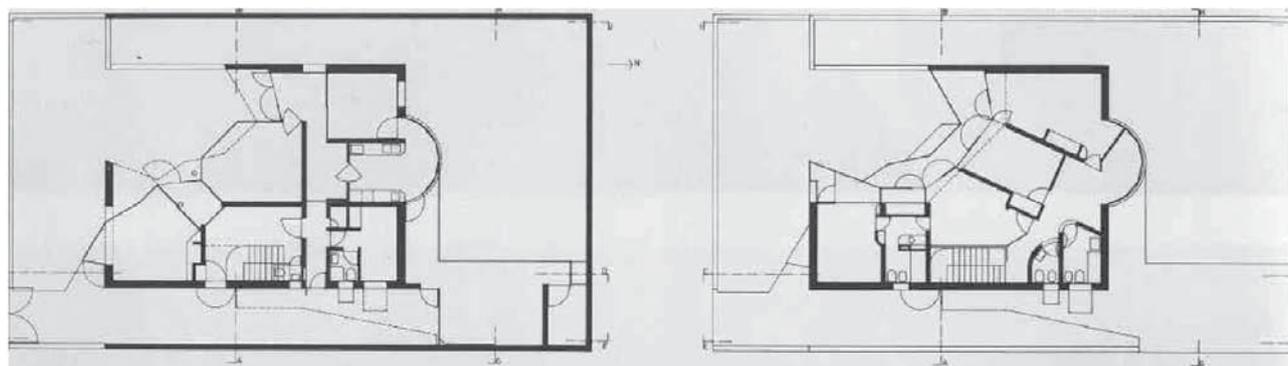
Plantas baixas. Fonte: TESTA, 1998, p. 40-41.
